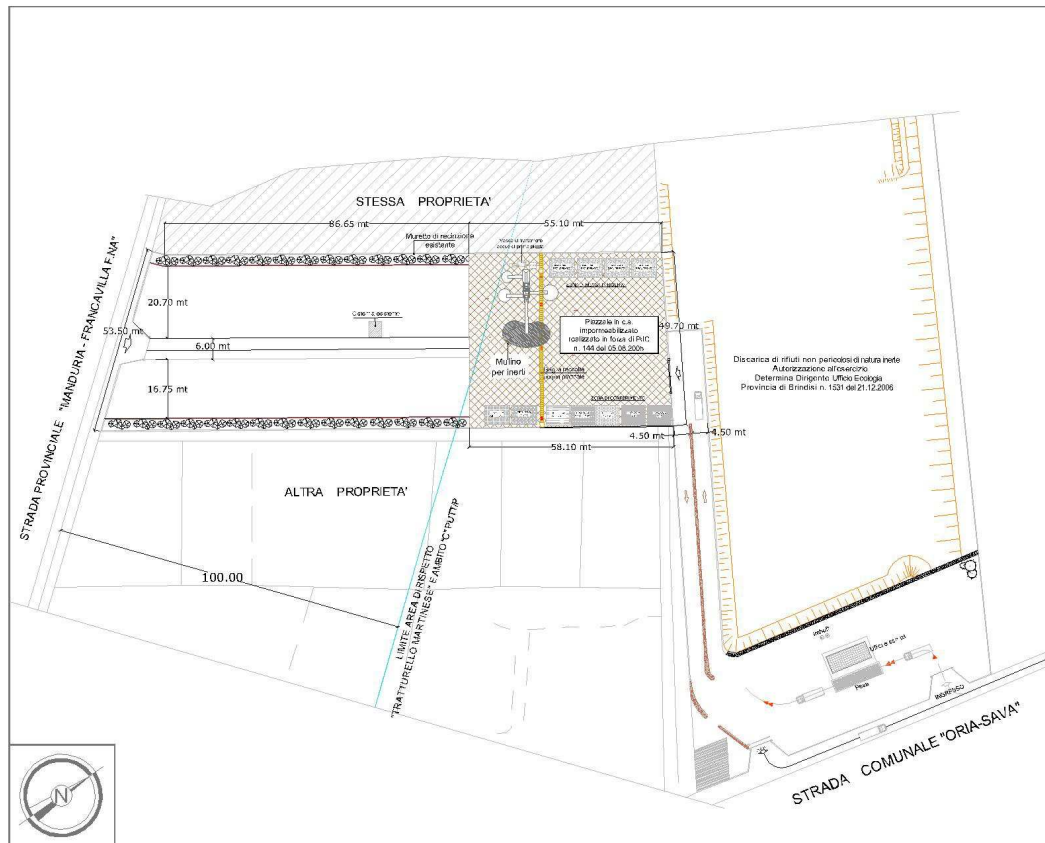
stralcio della TAV. S-01 allegata – Planimetria Impianto
